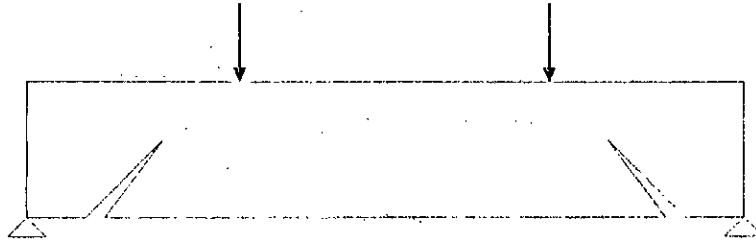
Inclinaison des fissures dans une poutre.
